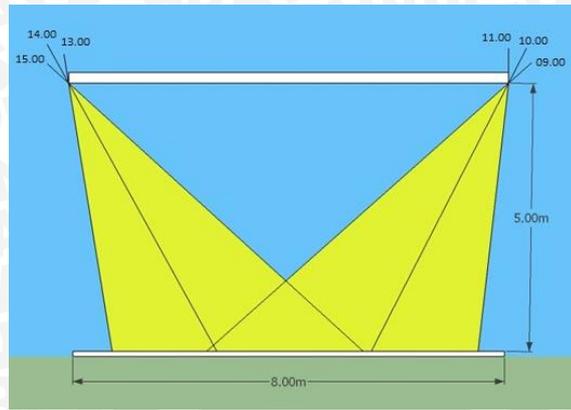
Penerangan yang baik dan ruang dengan dimensi yang baik
